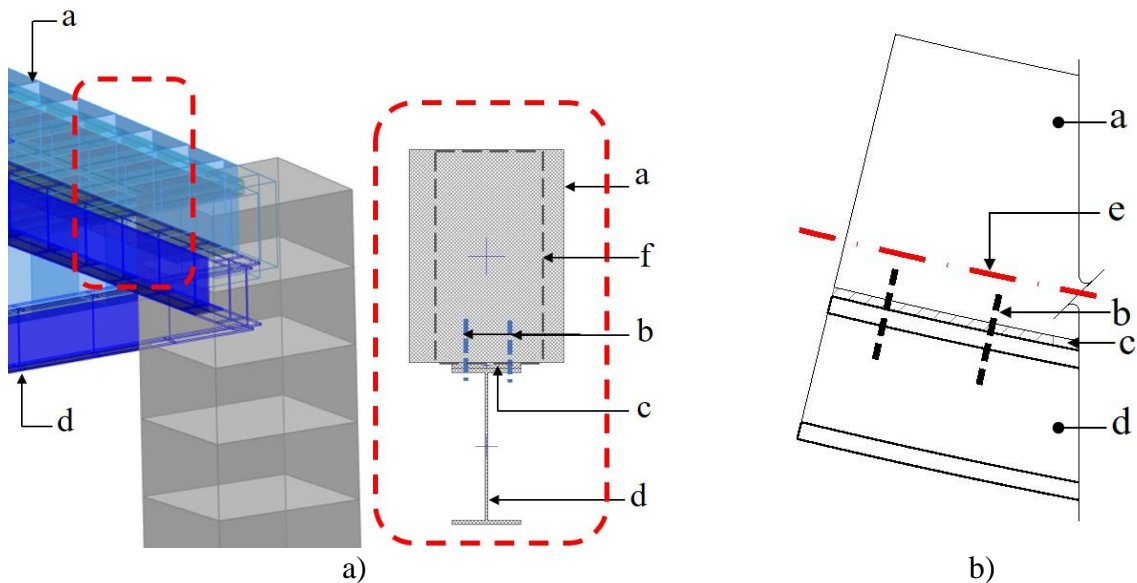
Vigas principais mistas; a) modelo estrutural com vigas mistas; b) detalhe de viga mista; onde: a = viga fissurada de concreto armado, b = conector mecânico, c = microconcreto não metálico, d = viga de aço, e = eixo neutro, f = seção transformada de viga de concreto considerada de acordo com a diminuição do momento de inércia.
